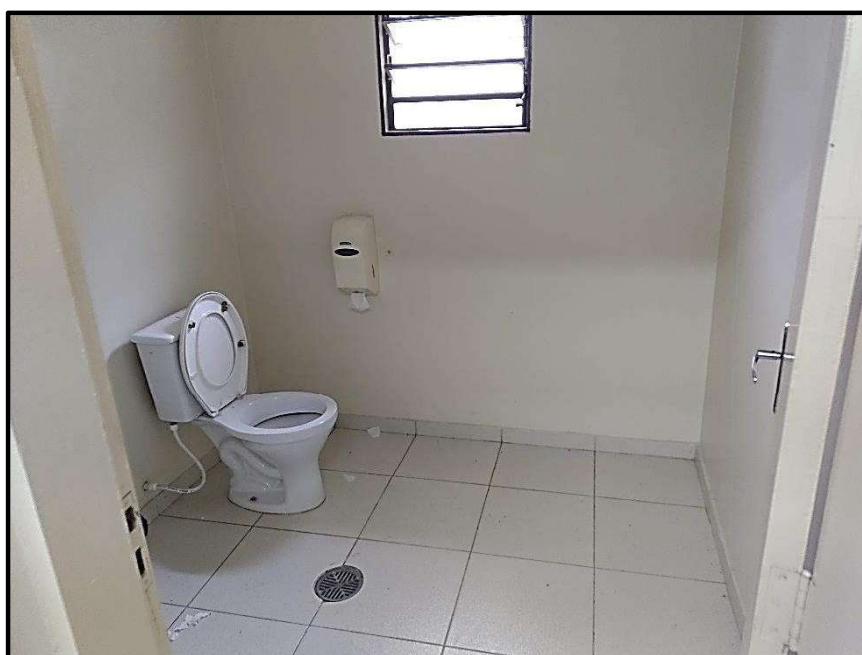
Aspecto interno de banheiro no pavimento inferior.
